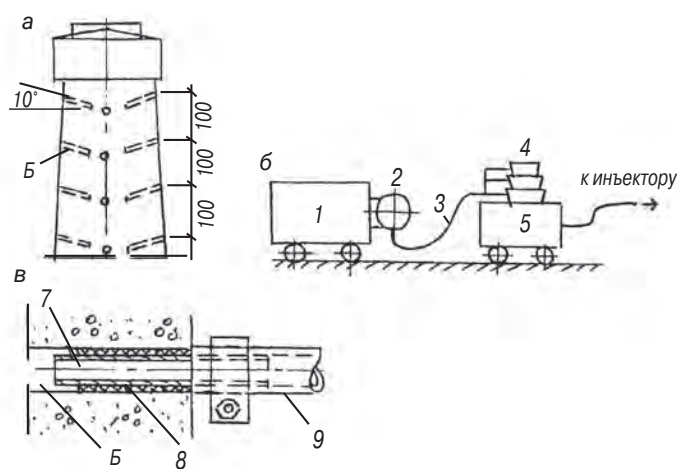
Инъектирование кладки опоры: а – положение скважин; б – схема насосной установки; в – инъектор; 1 – компрессор; 2 – воздухосборник; 3 – шланг; 4 – загрузочный барабан; 5 – смеситель; 6 – скважина; 7 – инъектор; 8 – пакля; 9 – резиновый шланг
